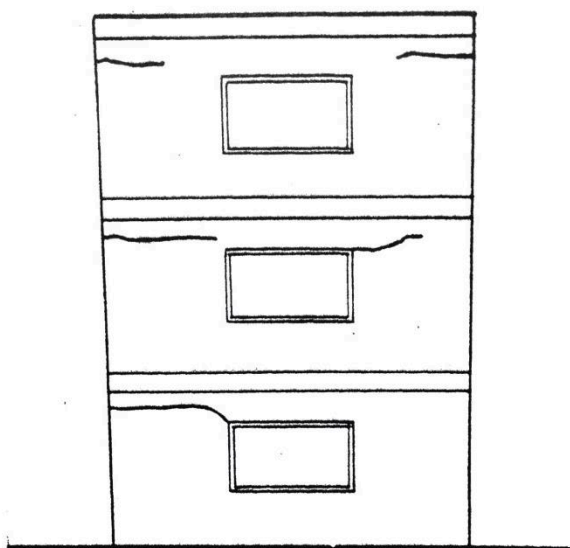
Fissuras em paredes externas, causadas pela retração de lajes intermediárias (THOMAZ, 1989).
